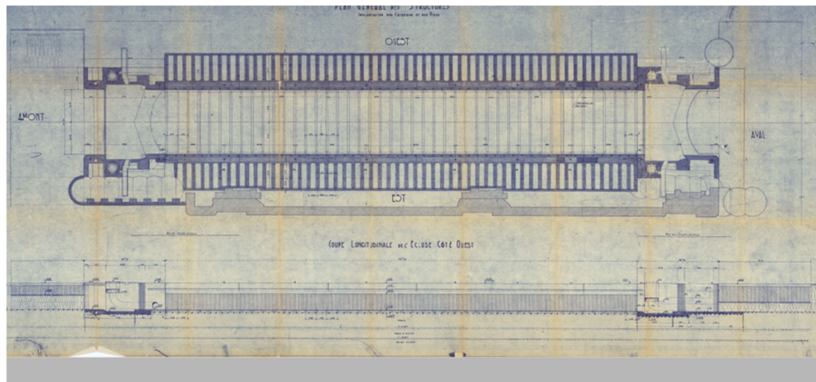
écluse Ouest de Ouistreham- Vue en plan des structures et coupe longitudinale (plan 23 archives DREAL, boîte 40)
